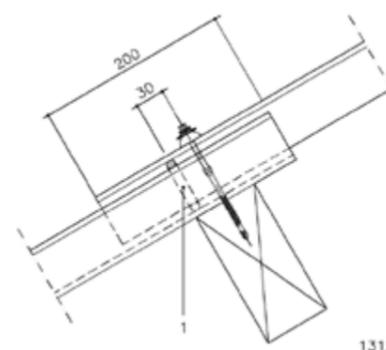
Pose du cordon d'étanchéité dans le recouvrement longitudinal [profil ECOLOR et ECOLOR EXTRA]
